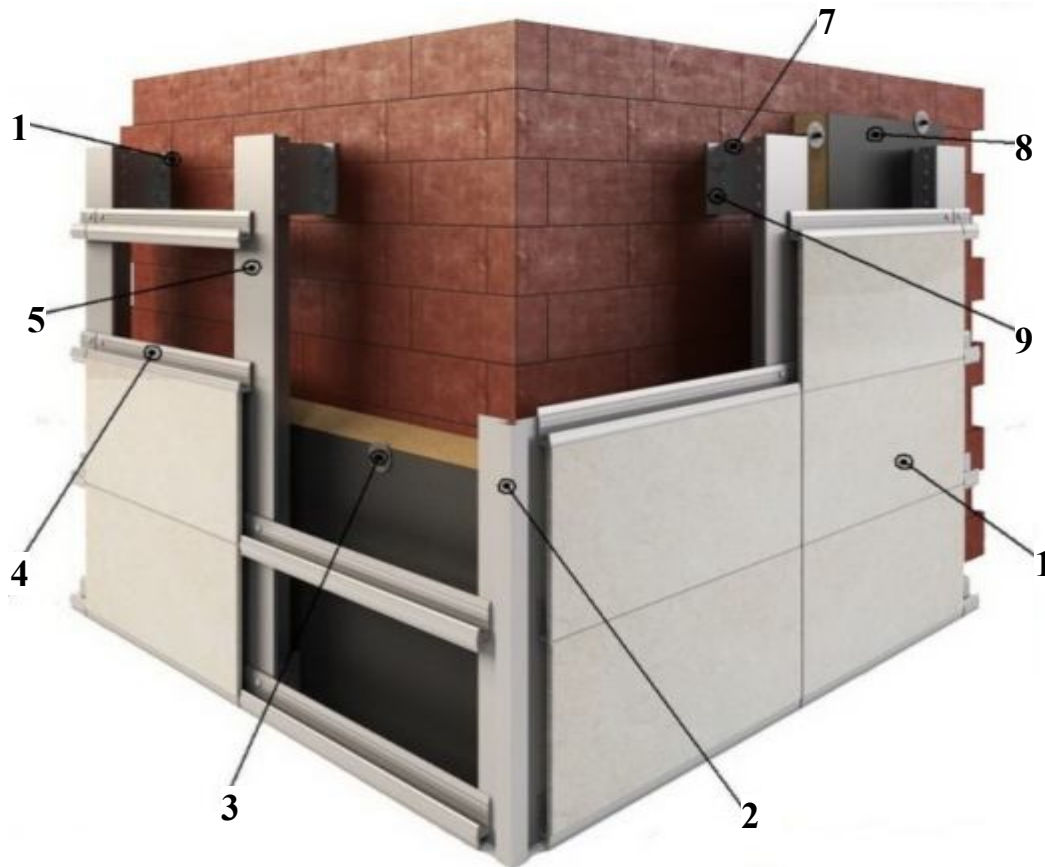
Обличкування фасаду натуральним каменем:
